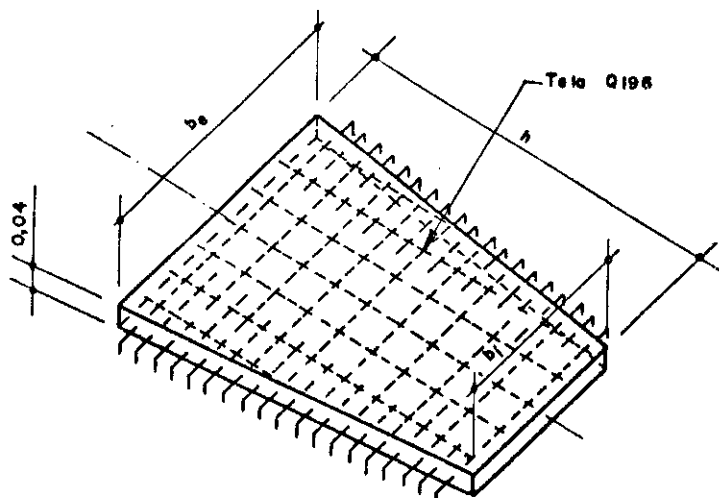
Detalhes da junta e das placas (med. em m)
